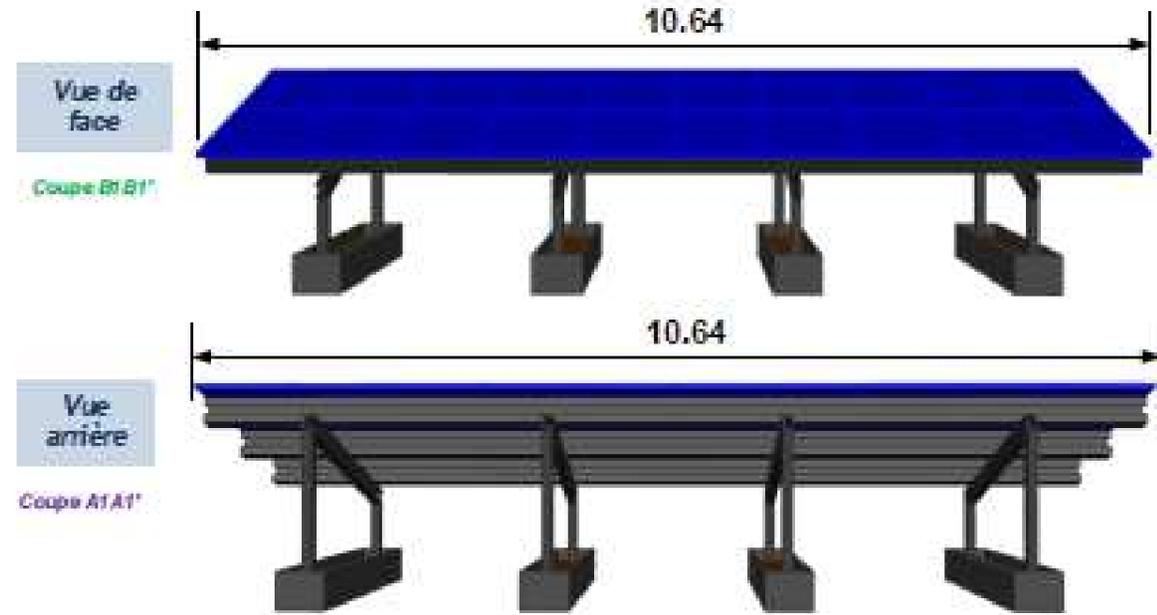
Schéma d'une structure fixe sur fondation hors-sol
